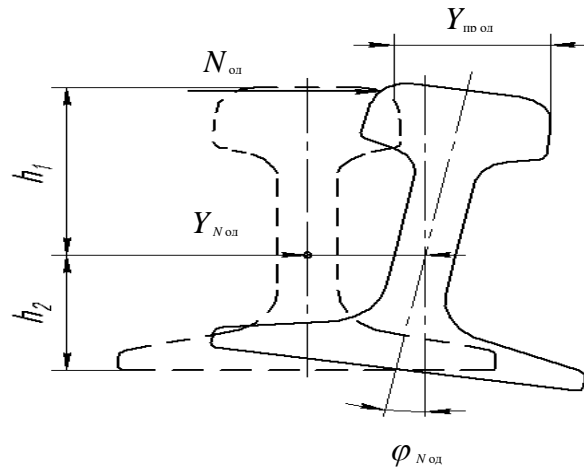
Розрахункова схема для визначення бічного відтискання головки рейки
